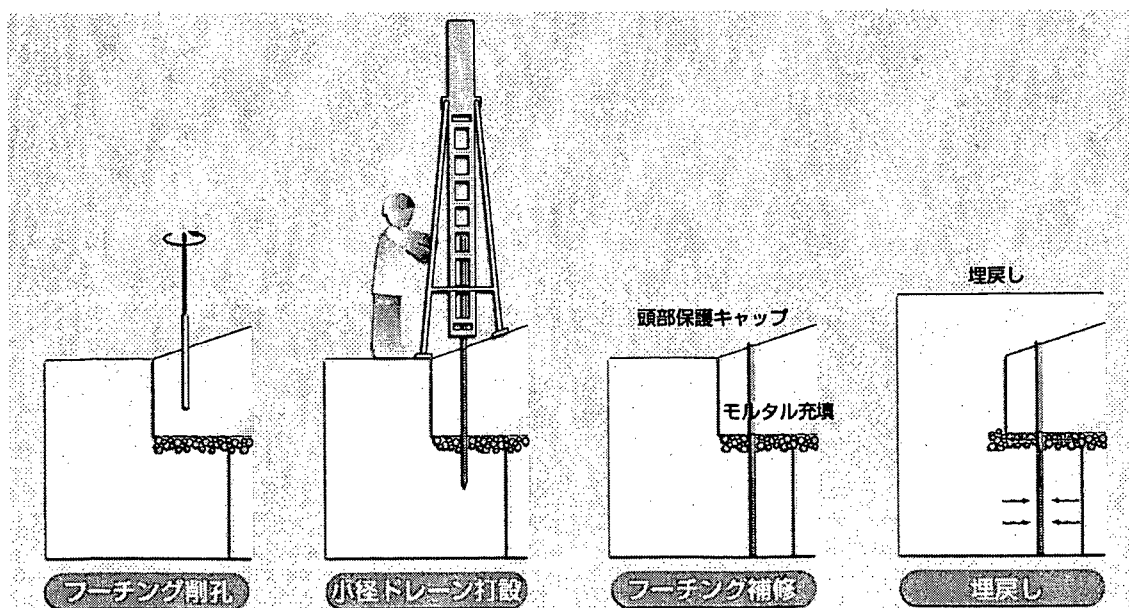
フーチング直下部の施工例（施工機械：衝撃式削進機）
